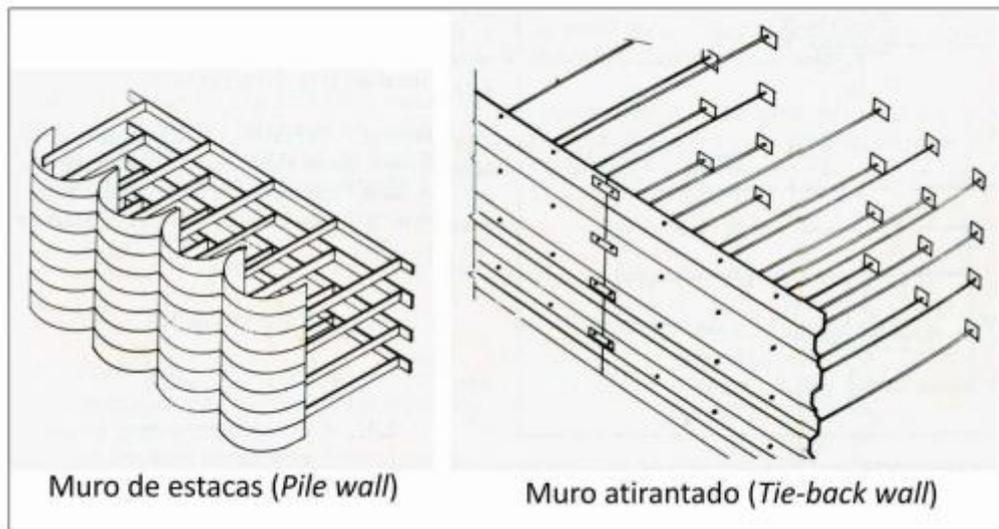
Esquema da estrutura de muros de estacas e do muro atirantado.
